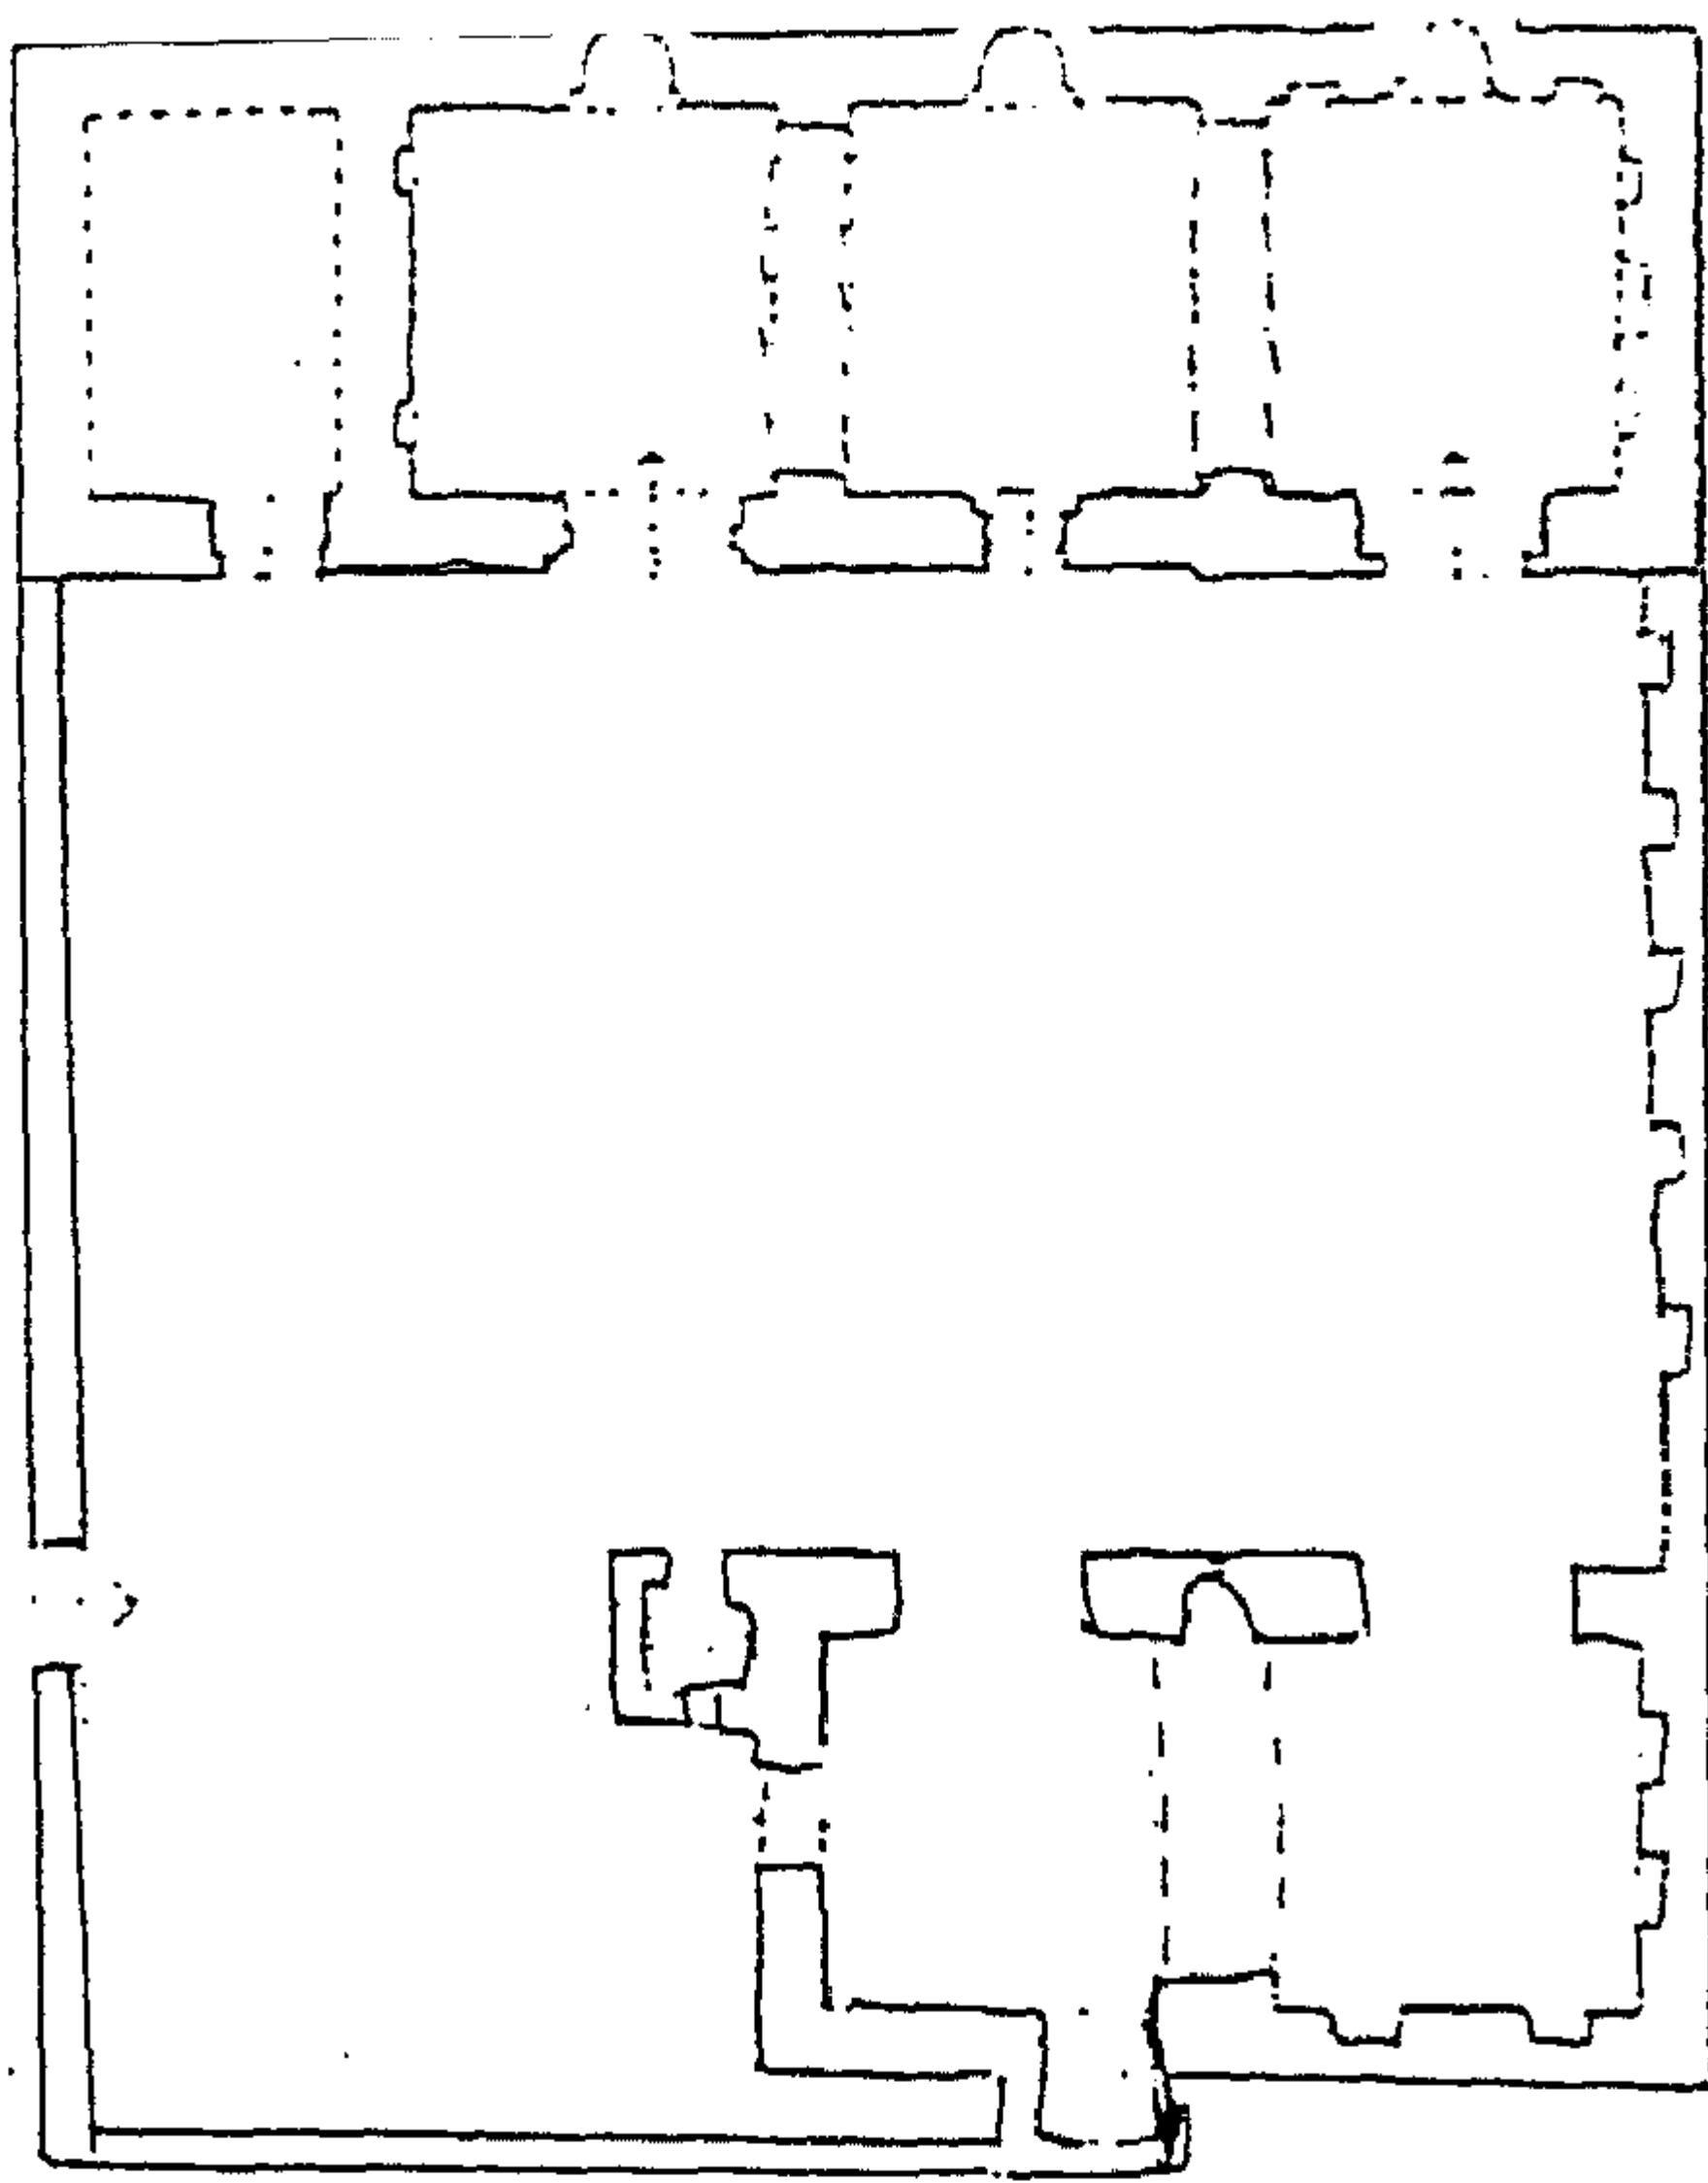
زويد، مسجد العدني، المسقط الأفقي
